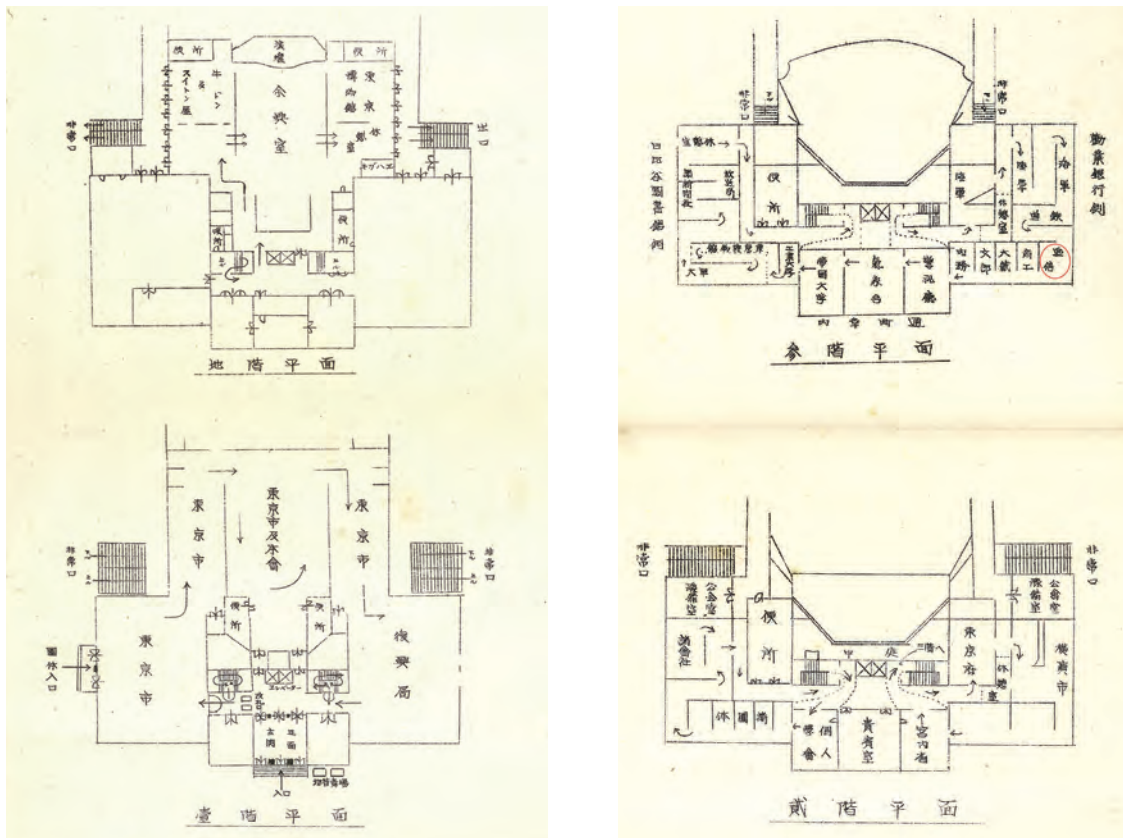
帝都復興展覧会展覧会場（市政会館）平面図
